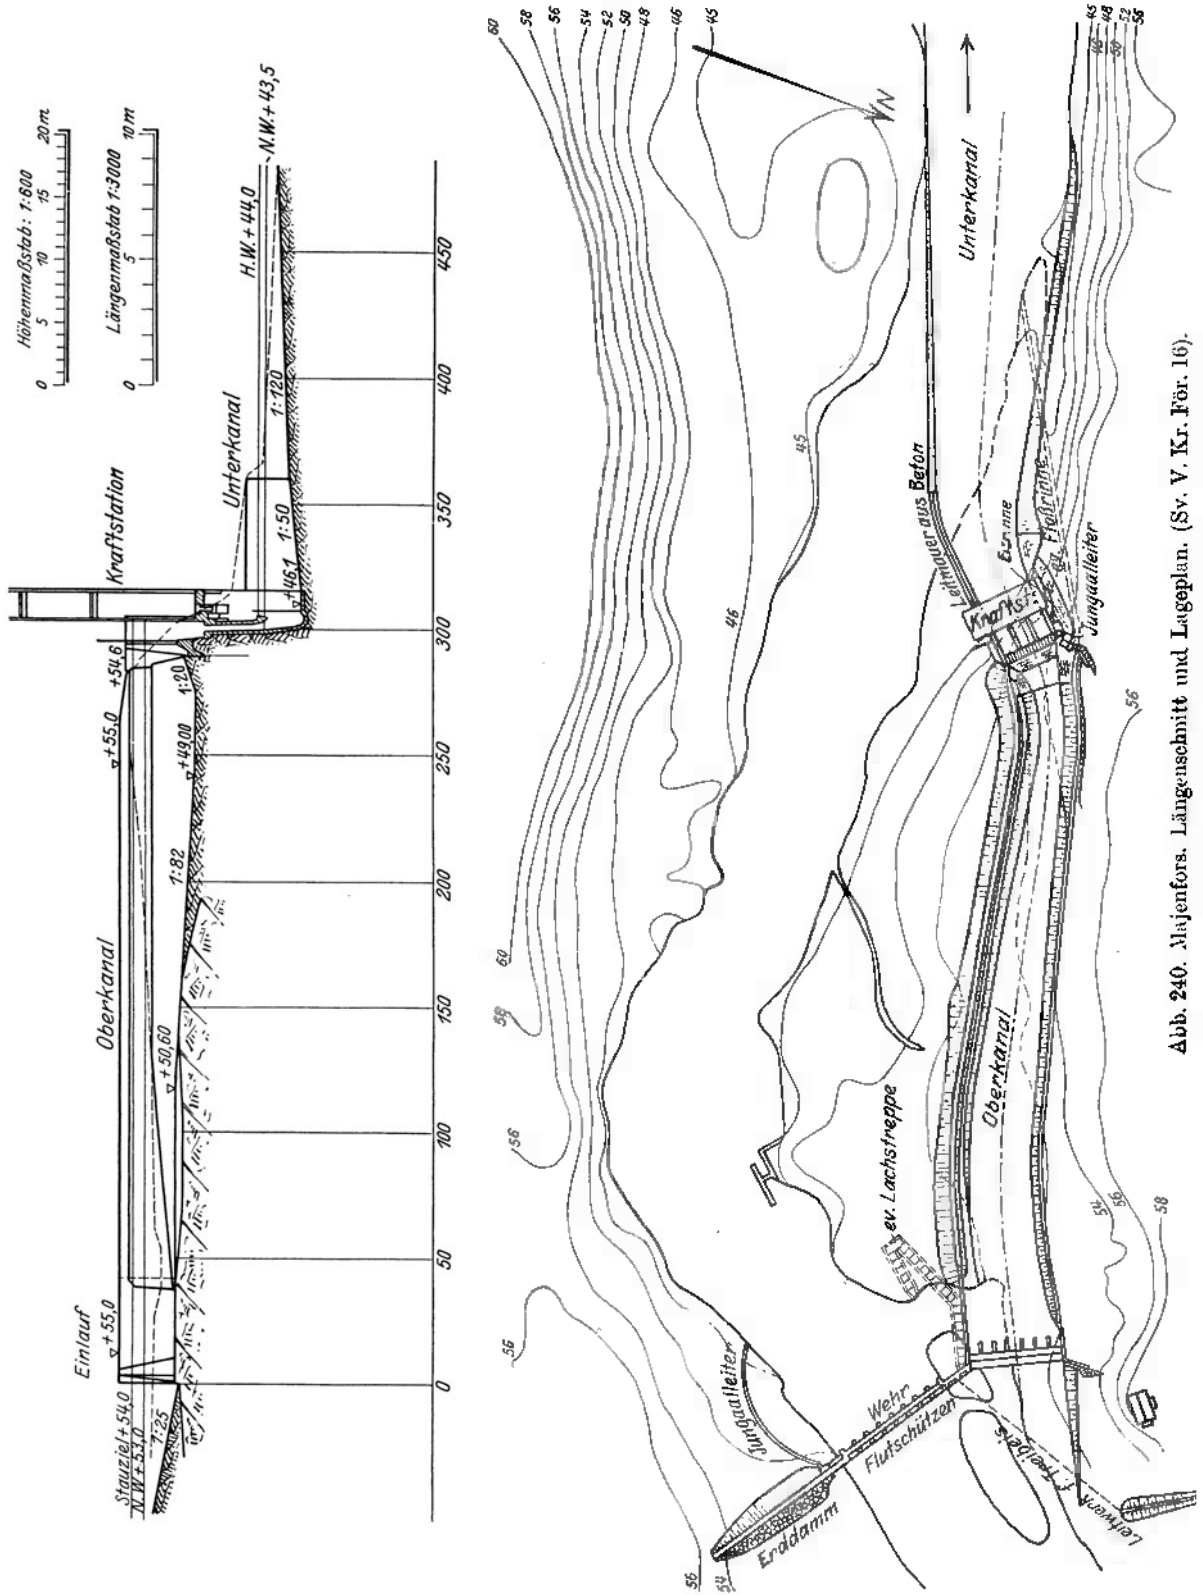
Majenfors. Längenschnitt und Lageplan. (Sv. V. Kr. För. 16).
